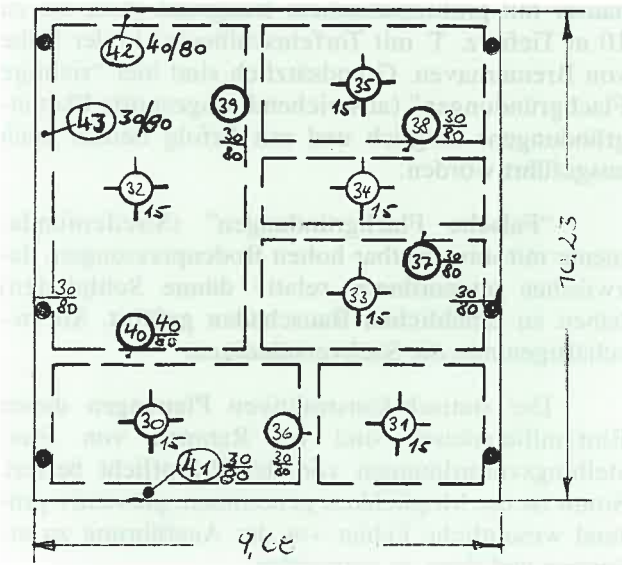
Der Gründungskörper: Stahlbetonsohlplatte $d = 15 \text{ cm}$, Balkenrost, ●: sechs Bohrpfähle
